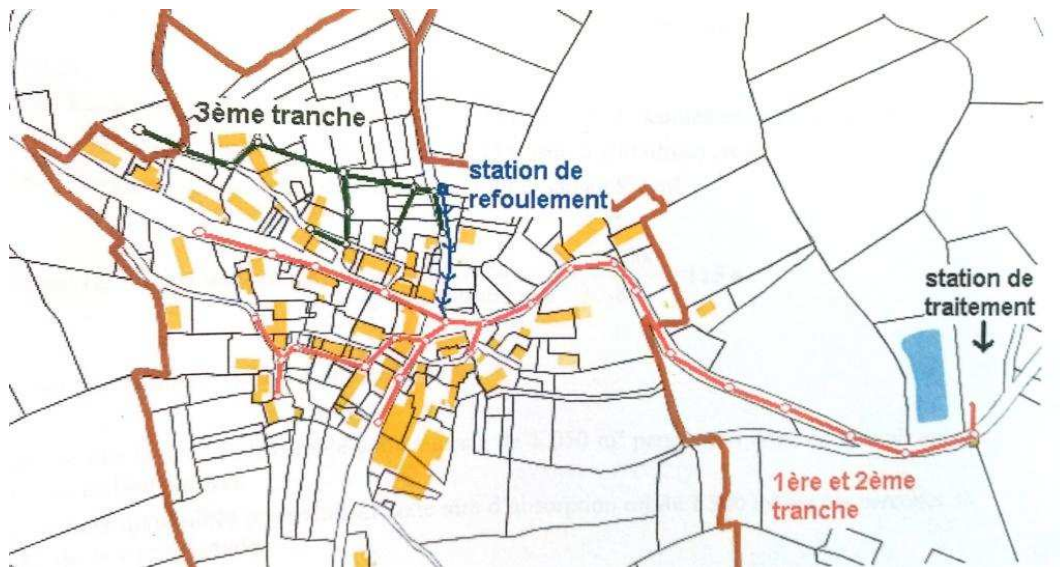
Plan du réseau d'assainissement collectif du hameau de La Chaise (source Commune de Planchez)
